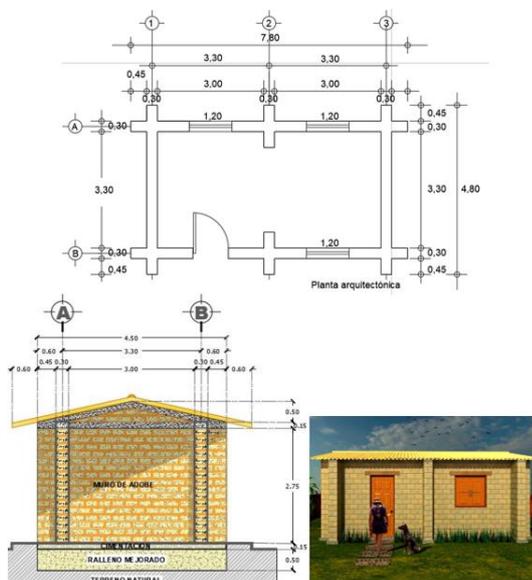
Fuente propia. Propuesta de cuarto redondo de adobe
